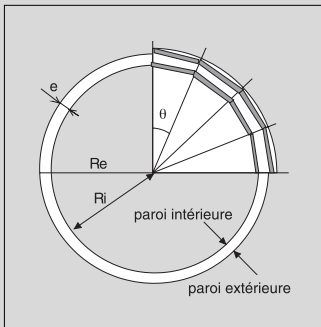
Coffrage d'un réservoir circulaire en 16 éléments (vue en coupe).
